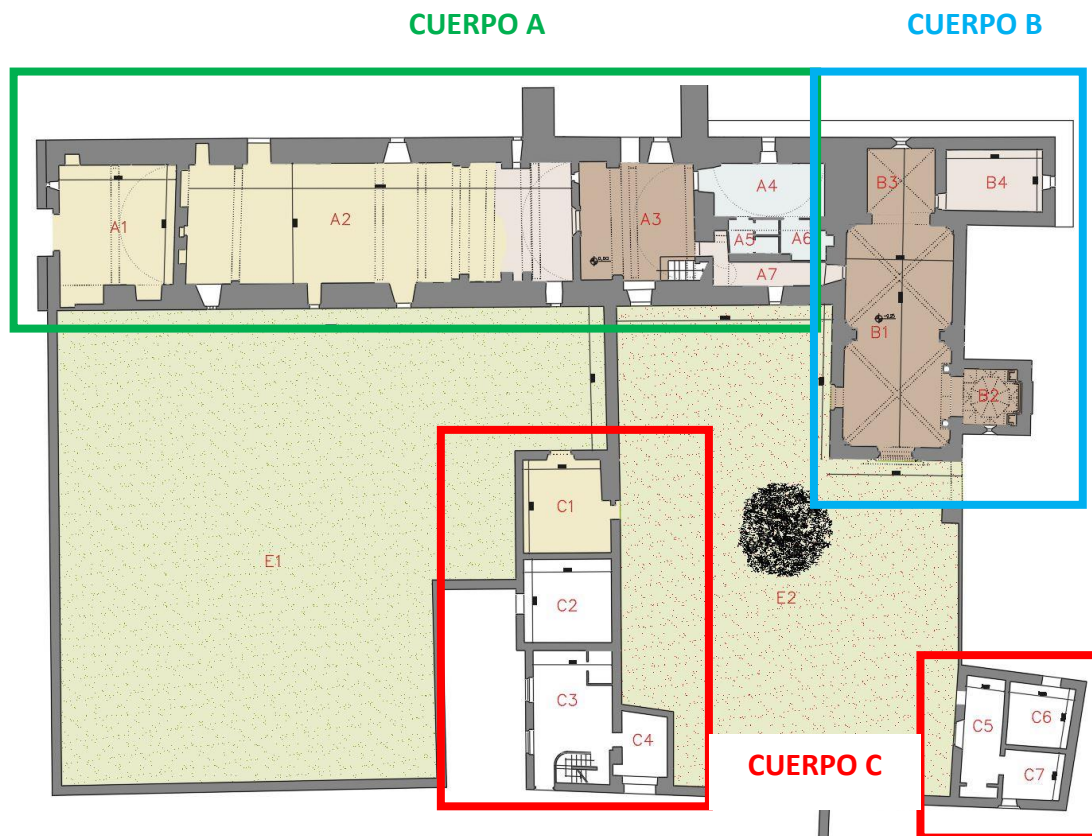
Planos De La Planta Baja Del Monasterio De Santa María De La Justicia
